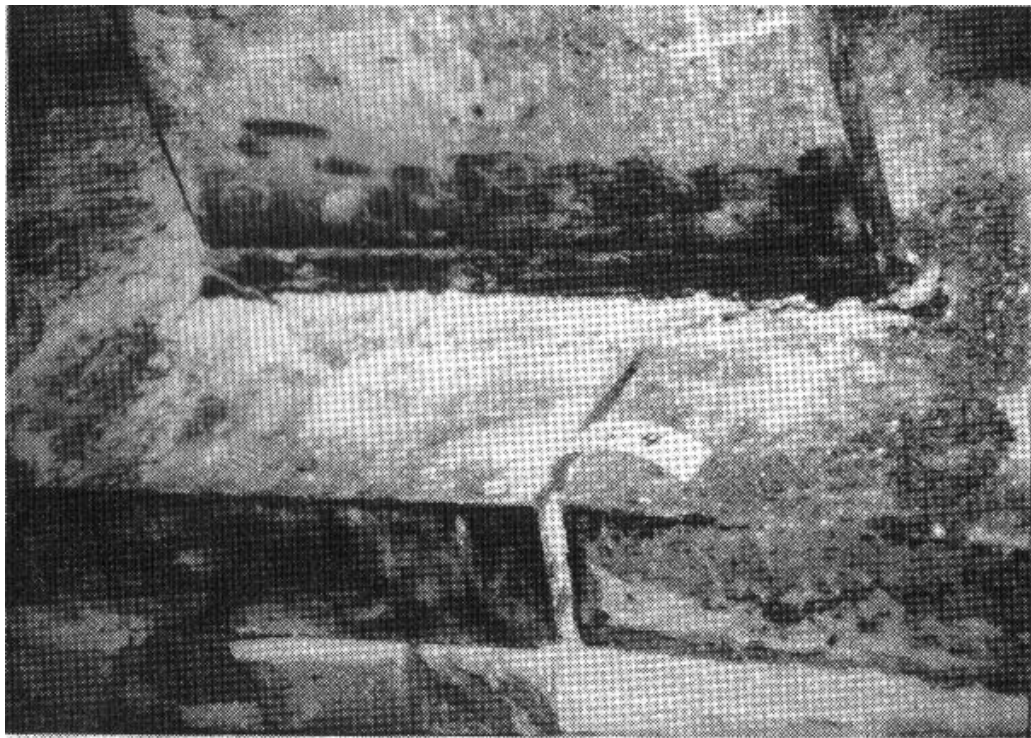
Se pueden apreciar el daño causado por el deslizamiento de las barras de anclaje en los dados de concreto. Ref. 5
